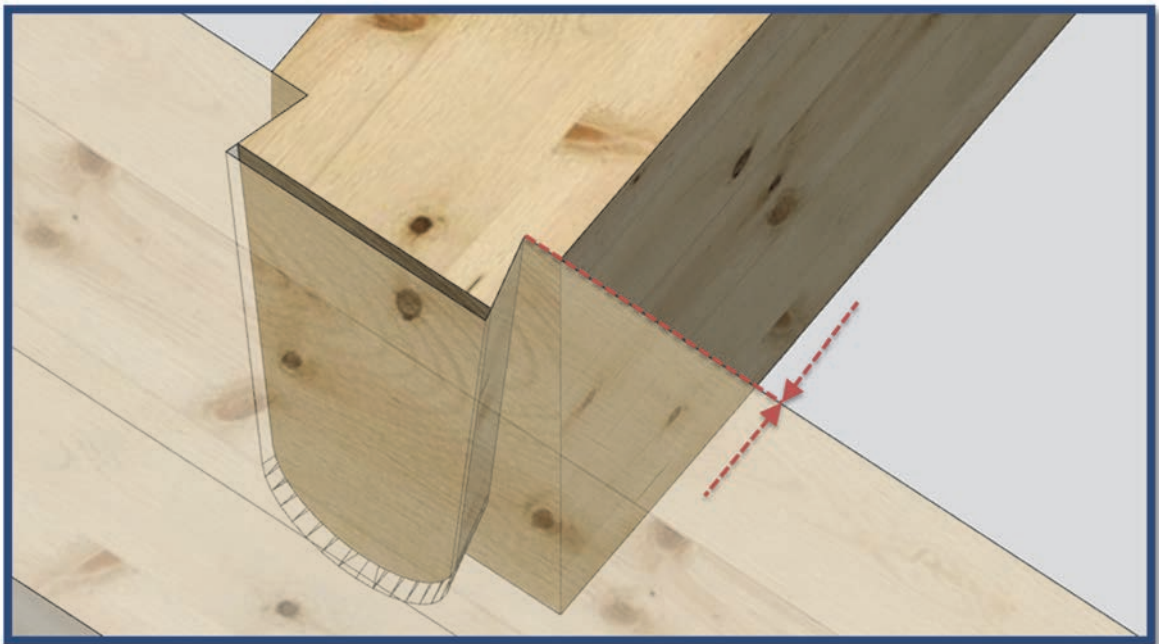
"HOLGURA": distancia entre testa de vigueta y cara de la viga en la que apoya
